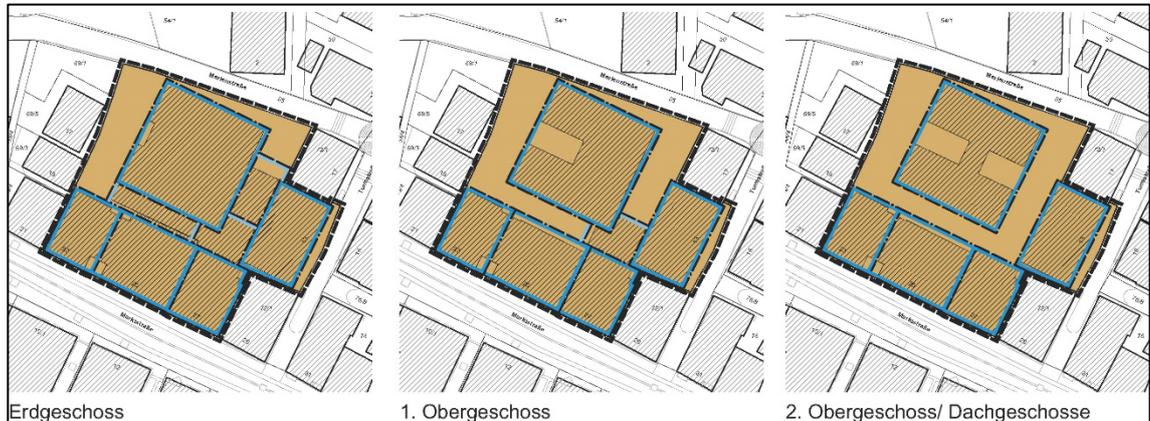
Festgesetzte Baugrenzen in Überlagerung mit der Gebäudeplanung, nach Geschossen
